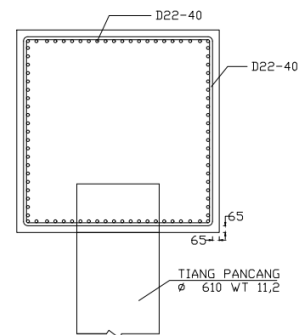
Detail Potongan Memanjang Pelat Dermaga
